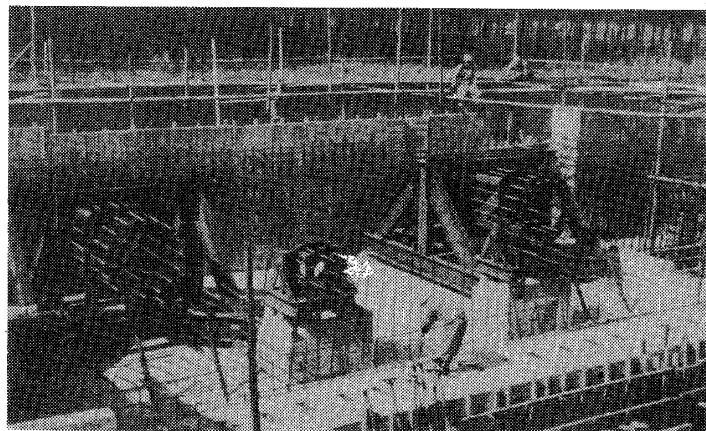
水平加振機およびガイドシリンダー用アンカーフレーム設置
